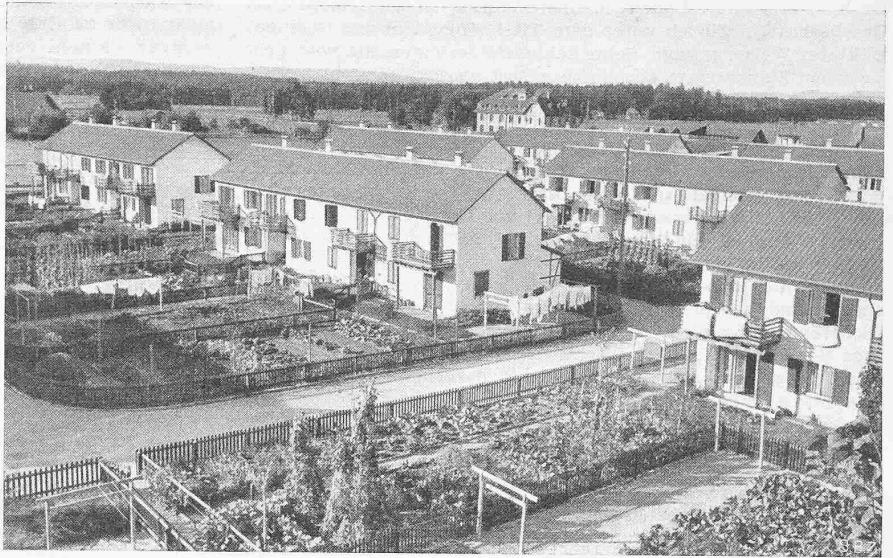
Ueberblick aus Süden, Typen A, rechts am Bildrand Typ B (Grundriss davon Seite 31)
